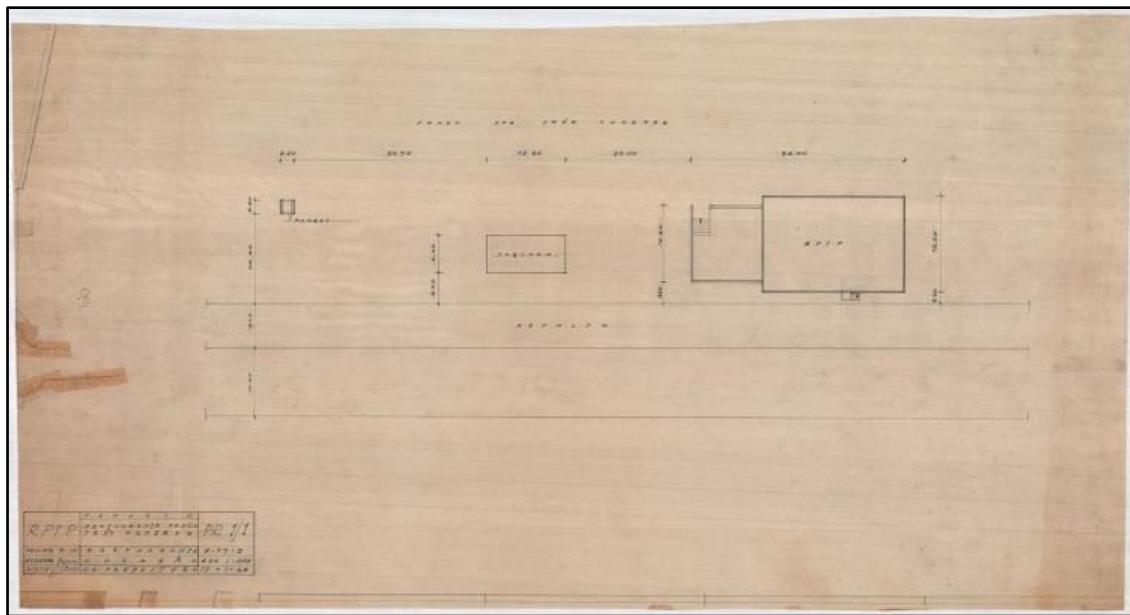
Jan. 1965 – RTPP-Restaurante. PR 1/1. Escala 1:200. Arquitetura – Locação – DA Prefeitura. Arquivo: e129-m5 (17) Fonte: ArPDF.
